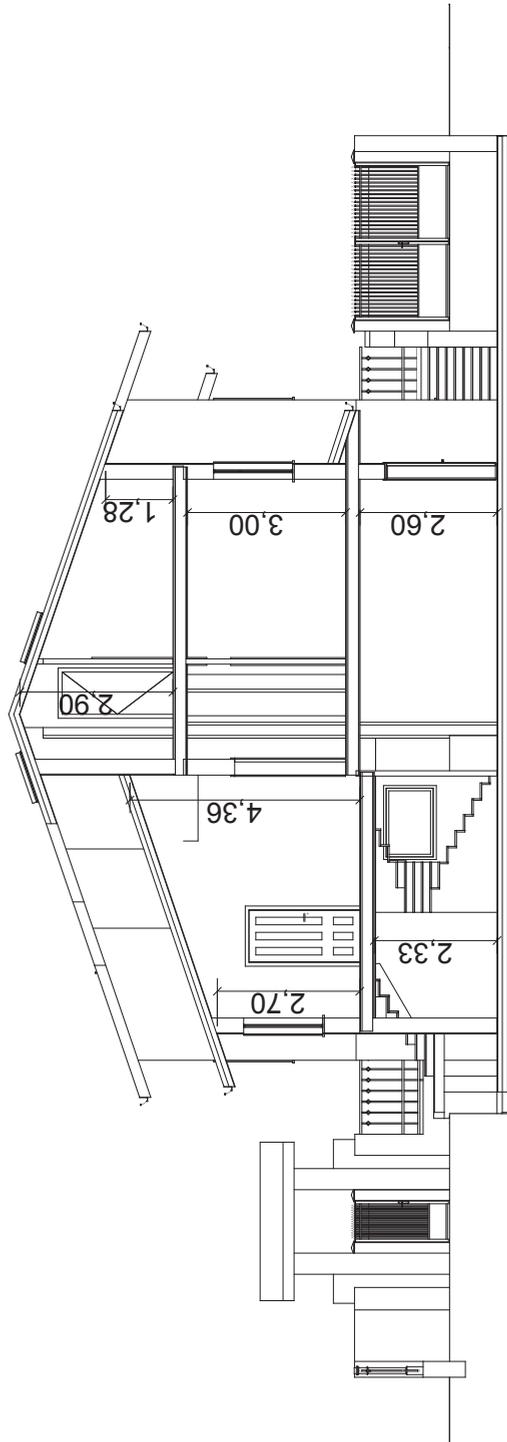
Sezione dell'abitazione: il piano interrato sarà realizzato in calcestruzzo armato
